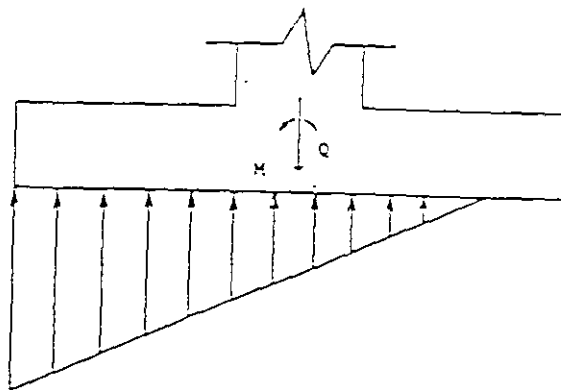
CARACTERÍSTICAS ESTRUCTURALES DE LA ZAPATA (EJEMPLO 5.3)
